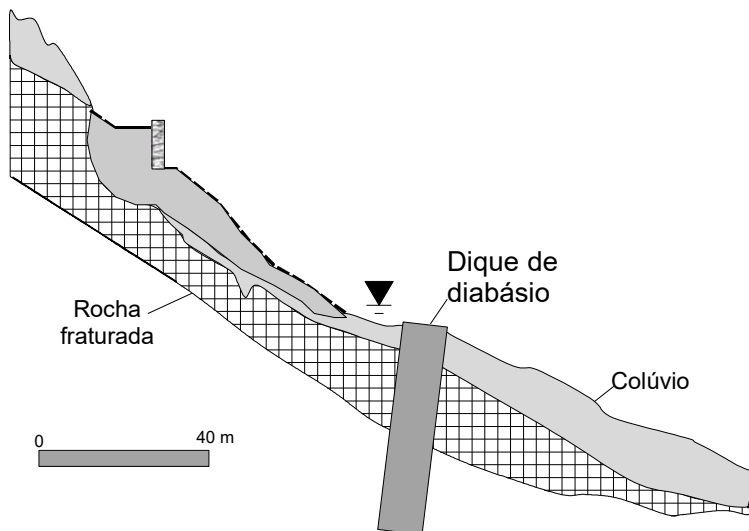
Perfil geotécnico da década de 90, após estudo detalhado da geologia estrutural
